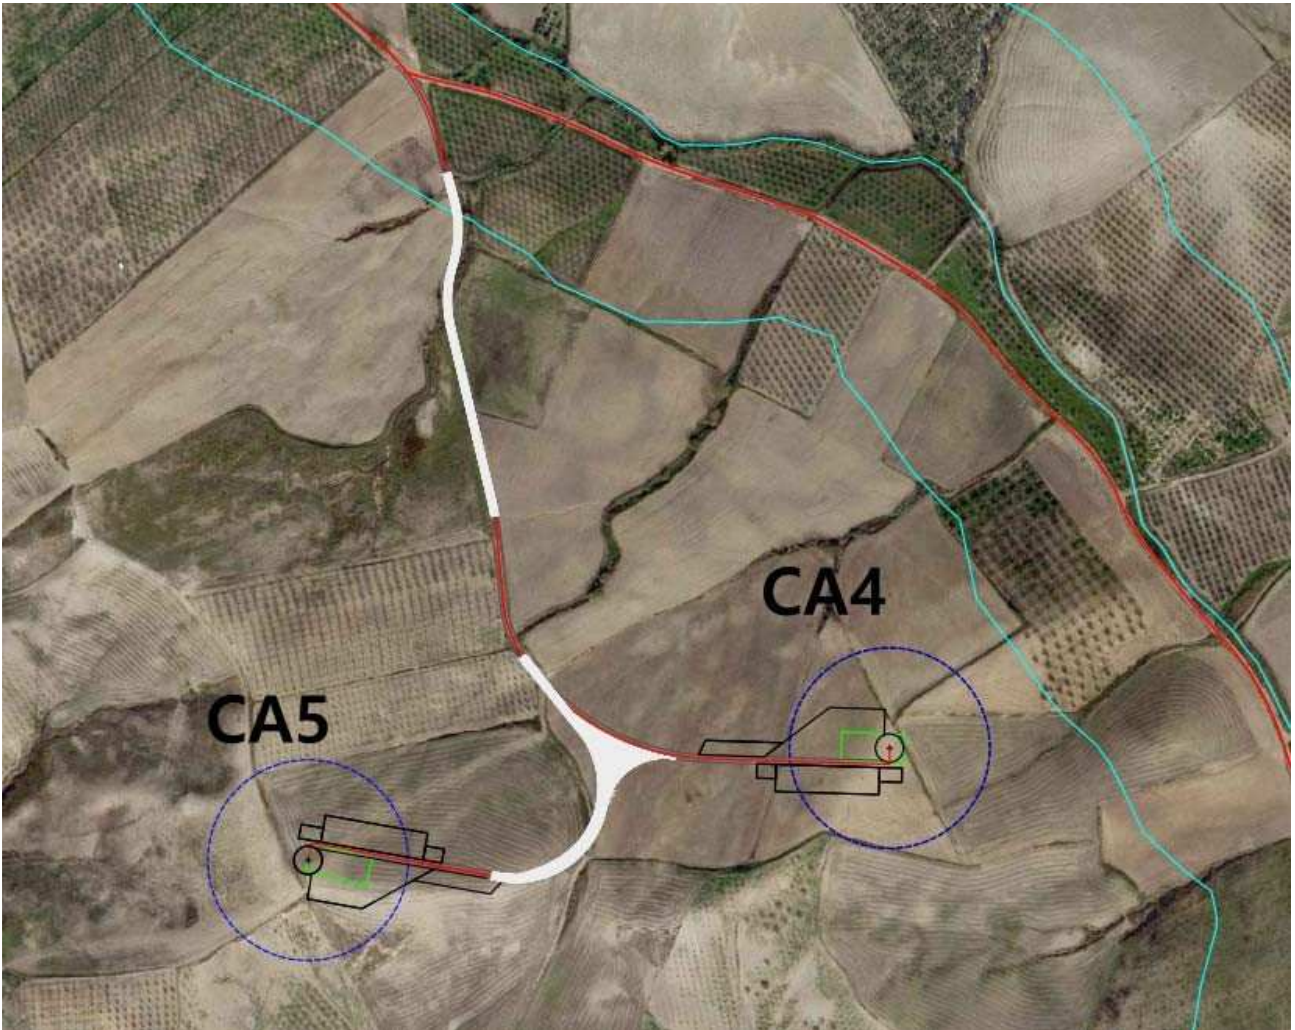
Ultima parte dell'accesso dalla posizione CA3
